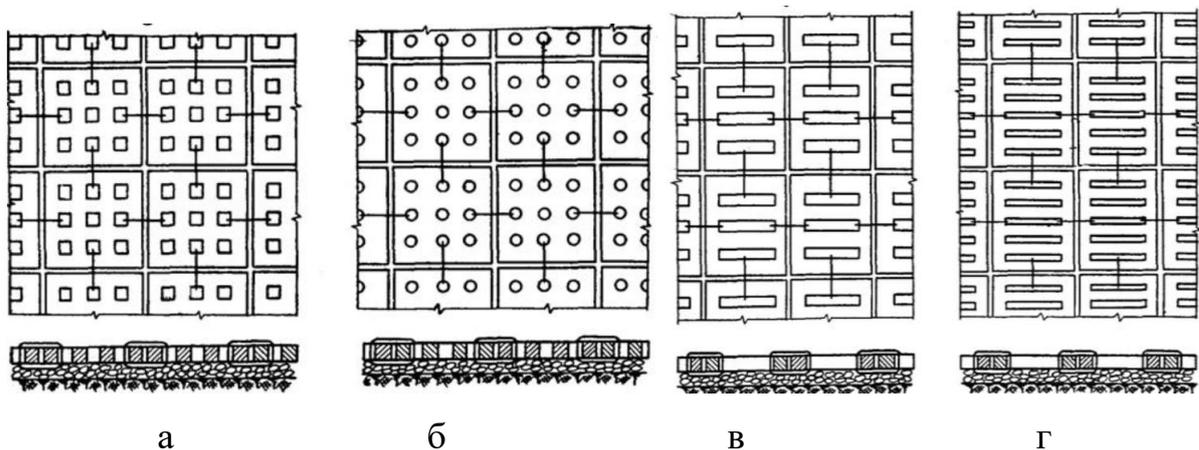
Сборные железобетонные сквозные плиты: а - с прямоугольными отверстиями; б - с круглыми отверстиями; в - с широкими прорезями; г - с узкими прорезями
